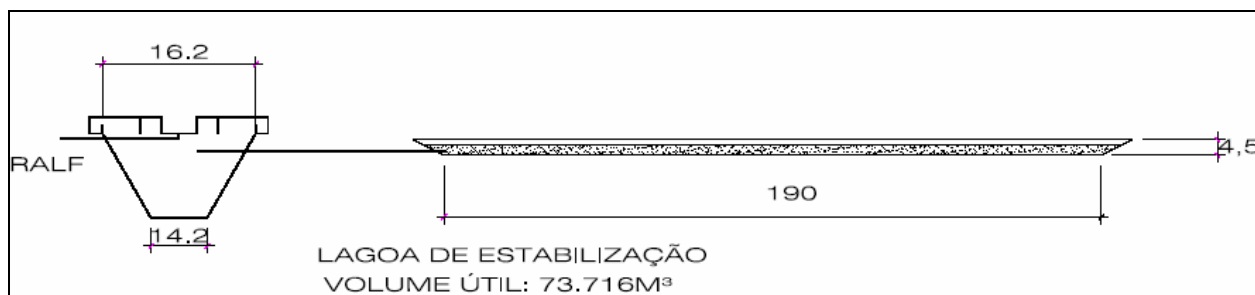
CORTE ESQUEMÁTICO DA ETE RONDA
